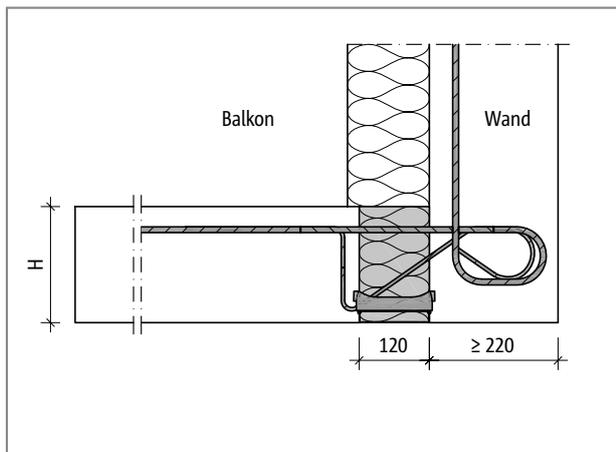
Schöck Isokorb® Typ KXT-WO: Wandanschluss nach oben bei Au-ßendämmung
